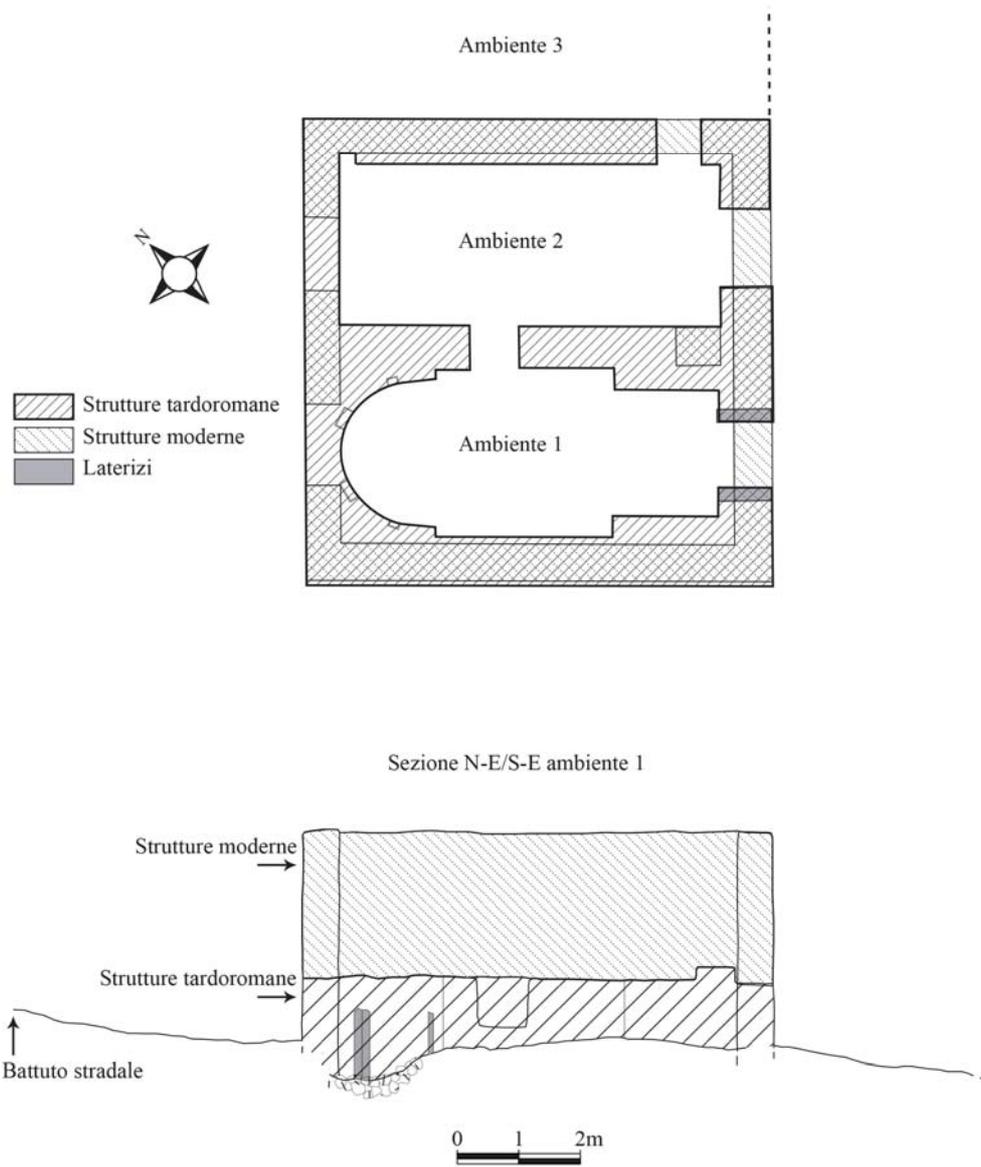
Planimetria delle strutture termali (rilievo ed elaborazione grafica dell'autore)
